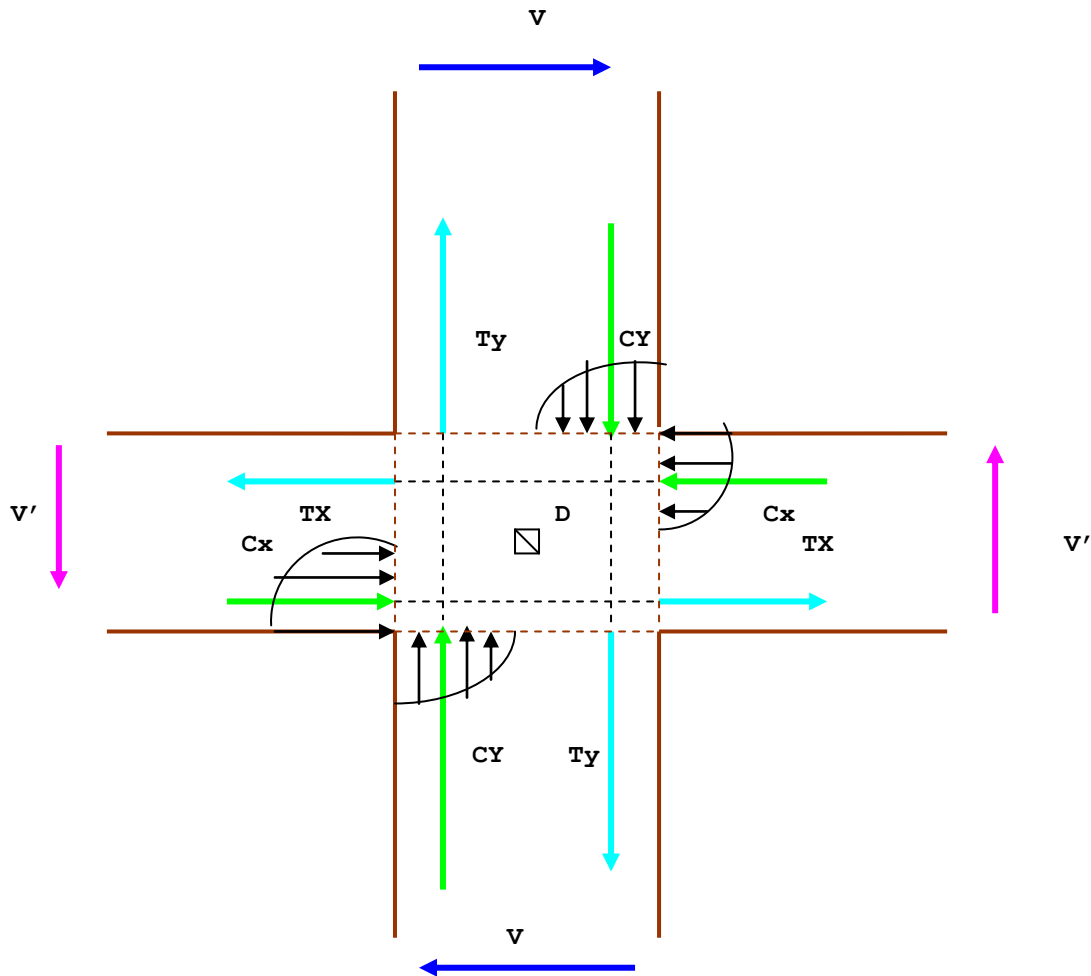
Comportamiento mecánico de una conexión viga - columna.
